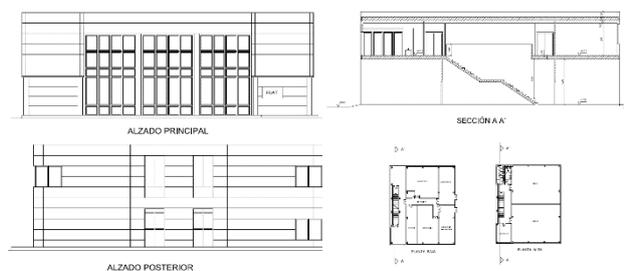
Alzados y Secciones de estado actual obtenidas tras la segunda investigación. (Planimetría facilitada por un alumno compañero de la escuela).
